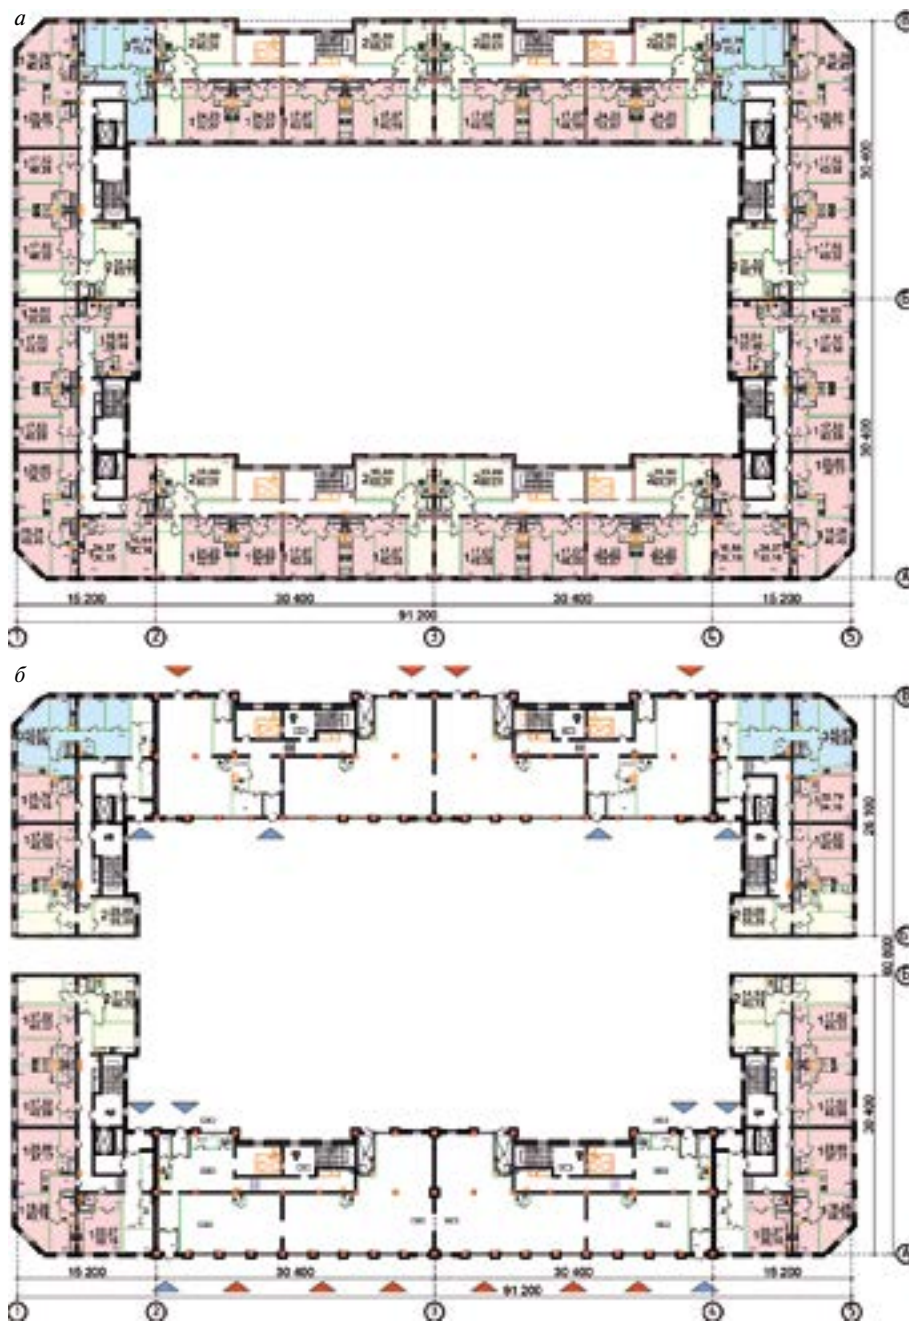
Пример квартальной застройки: а – план типовых этажей; б – план первого этажа
